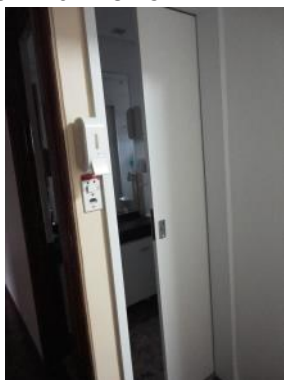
BanheiroImagem 5.80 - Banheiro reversível
